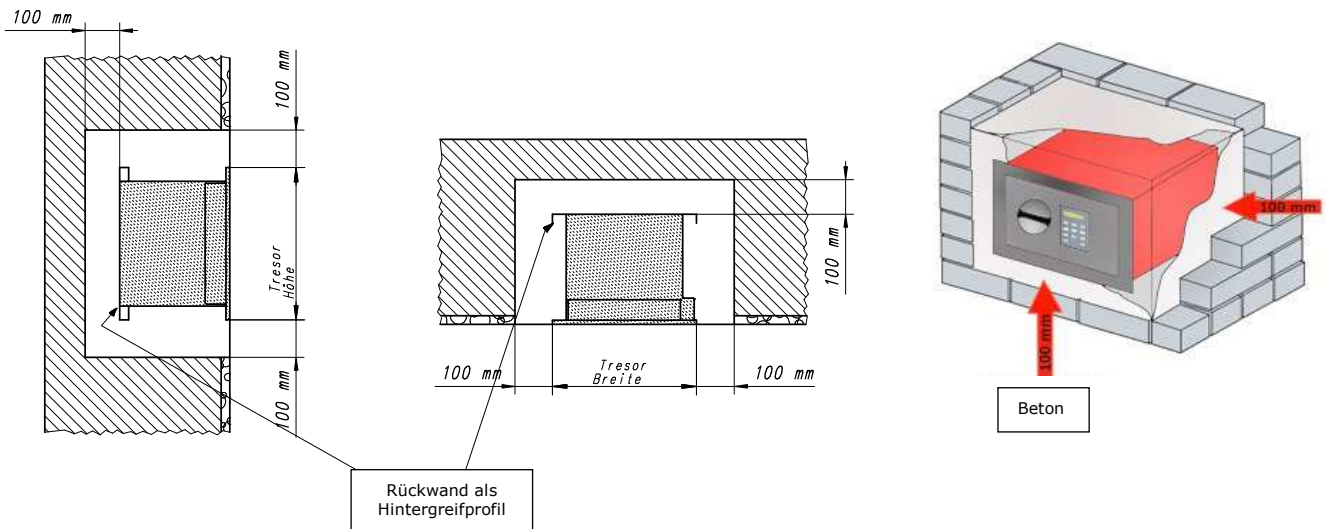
Mindestabmessung der Wandöffnung für Einbau Wandtresor
